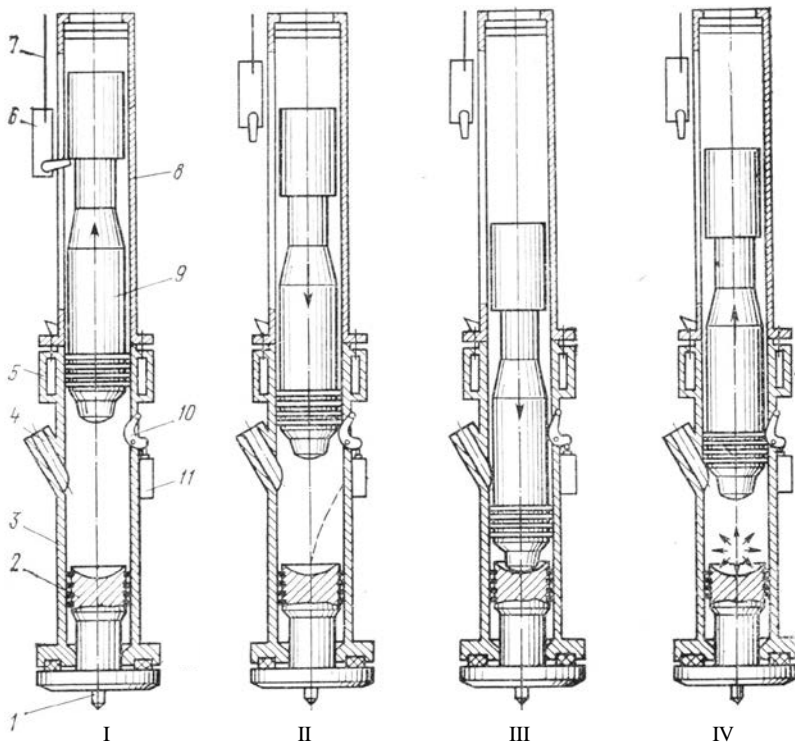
Конструкция и схема работы трубчатого дизель-молота: I – подъем ударной части; II – подача топлива в шабот и продувка цилиндра; III – удар по шаботу; IV – рабочий ход поршня, выхлоп: 1 – центровочный штырь; 2 – шабот; 3 – корпус цилиндра; 4 – выхлопные окна; 5 – топливный бак; 6 – пусковое устройство; 7 – канат лебедки копра; 8 – направляющая труба; 9 – поршень; 10 – приводной рычаг топливного насоса; 11 – топливный насос
